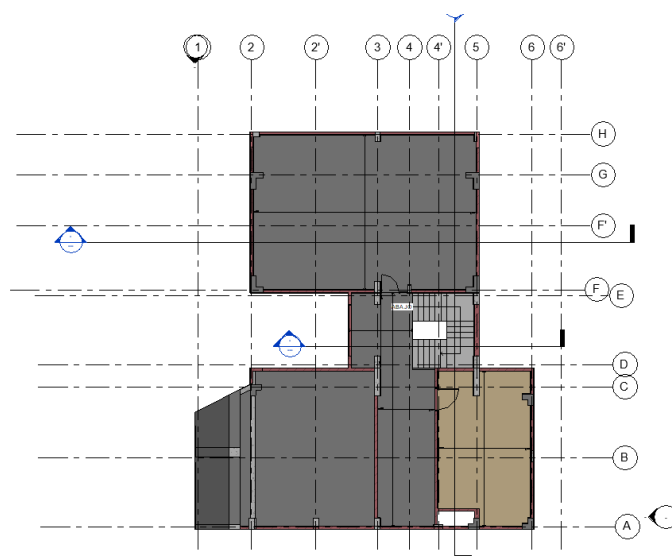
Vista en planta del modelamiento arquitectura tercer nivel
